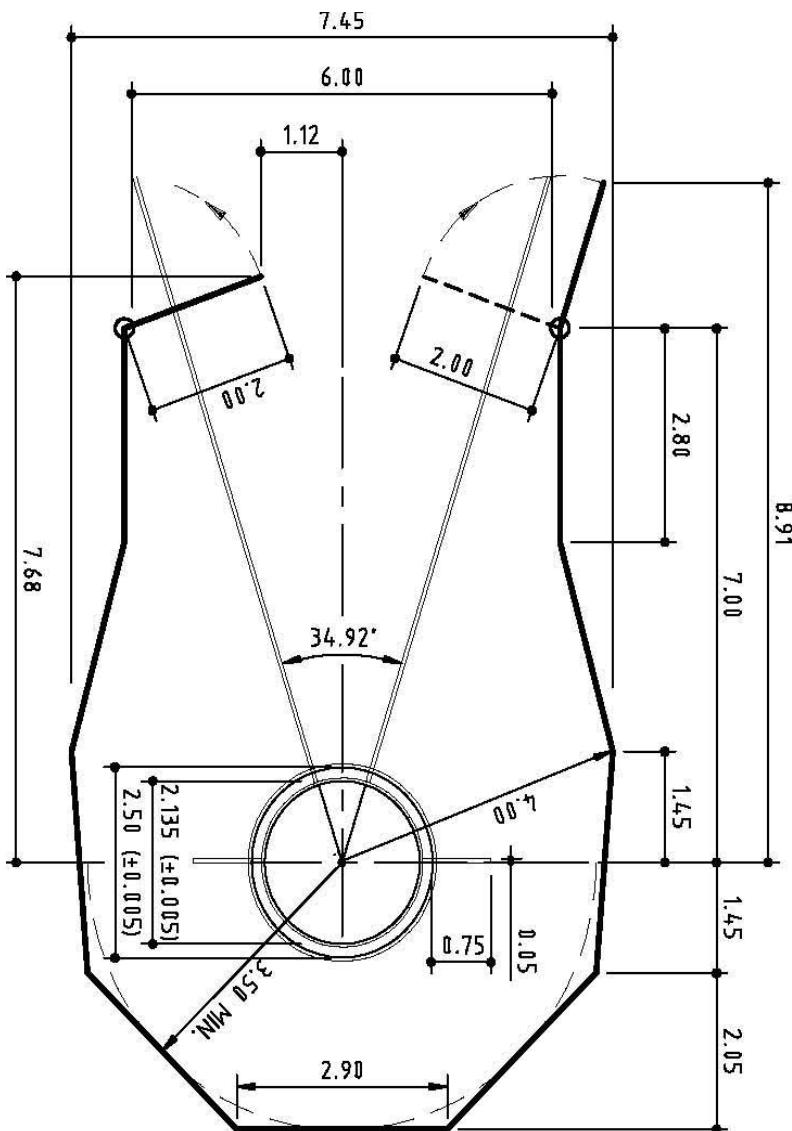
Сітка для метання молота й диска з концентричними колами
